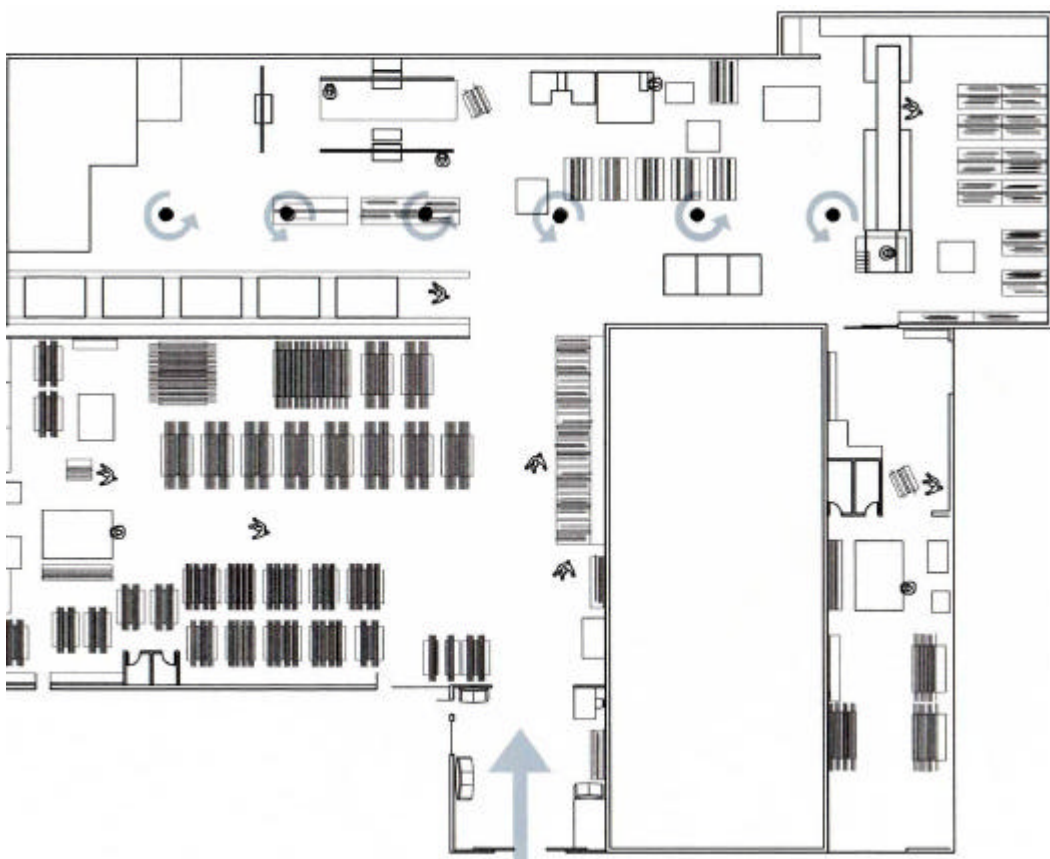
Planta baixa atual demonstrando através das flechas sistema de ventilação
